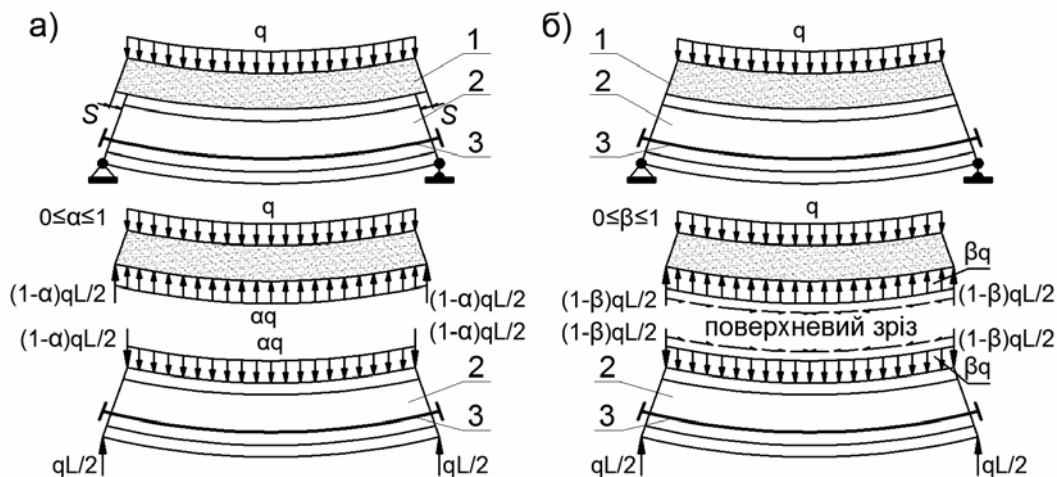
Варіанти загального деформування ПНСЗБ балок на стадії руйнування [5] залежно від умов з'єднання матеріалів: а) без зчеплення; б) з повним зчепленням: 1 – бетонна плита; 2 – сталевий профіль; 3 – затяжка.
